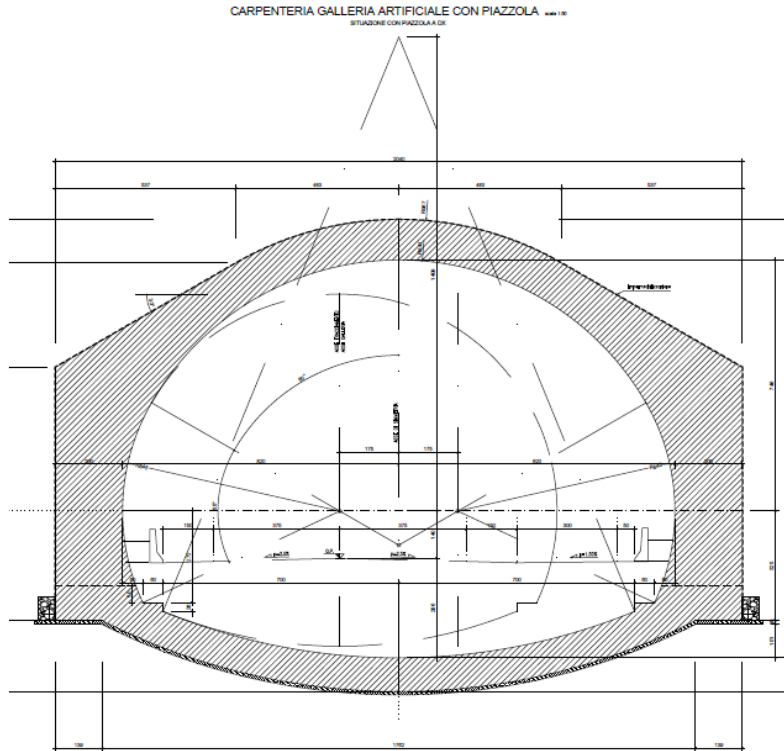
SEZIONE TRASVERSALE GALLERIA ARTIFICIALE CON PIAZZOLA
